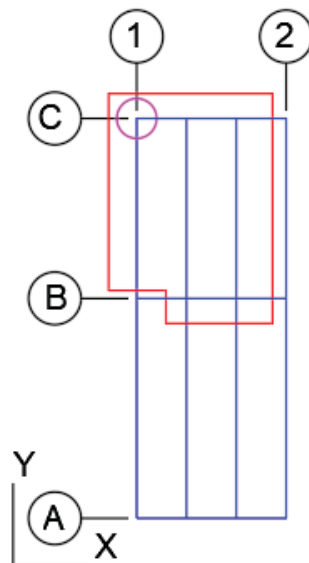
Segundo pilar retirado localizado no canto da estrutura na seção 1, região C.
